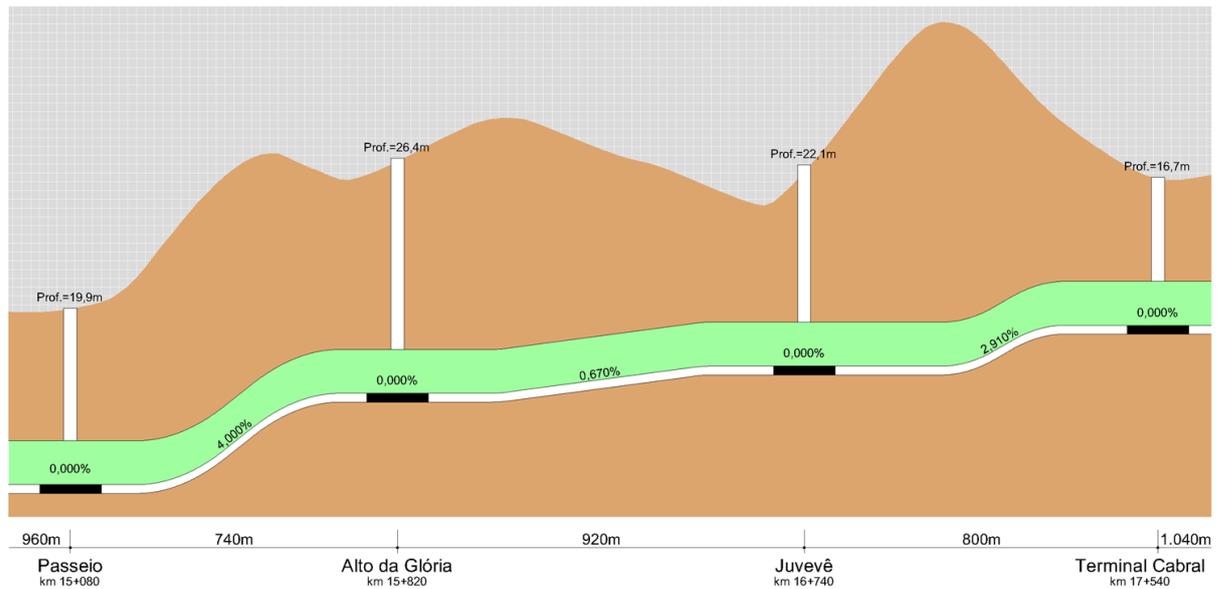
Perfil longitudinal do relevo do Eixo Norte.
